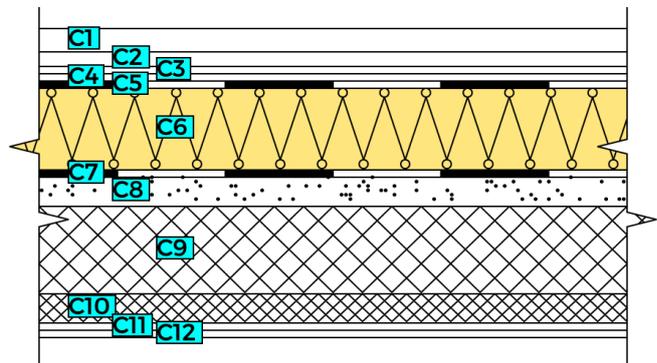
Toiture verte nommée « Toiture Plate 18 » issue du site web TOTEM
